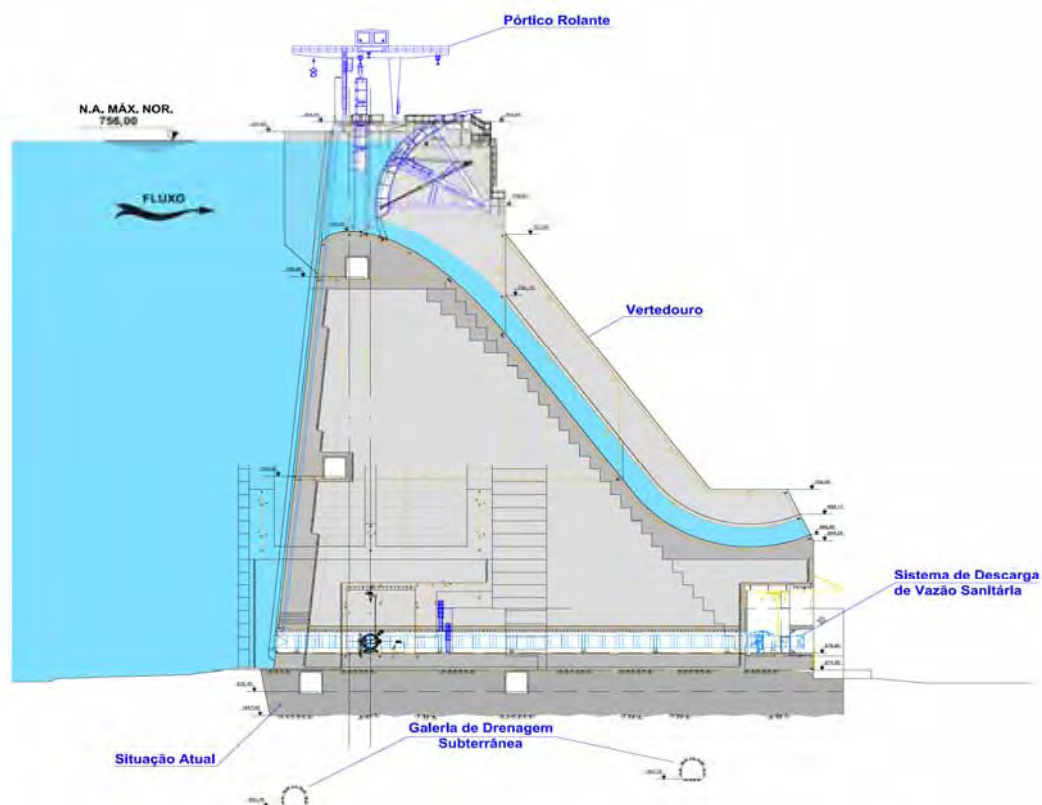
UHE Serra do Facão: Vertedouro, implantado sobre a barragem de CCR, corte transversal.
